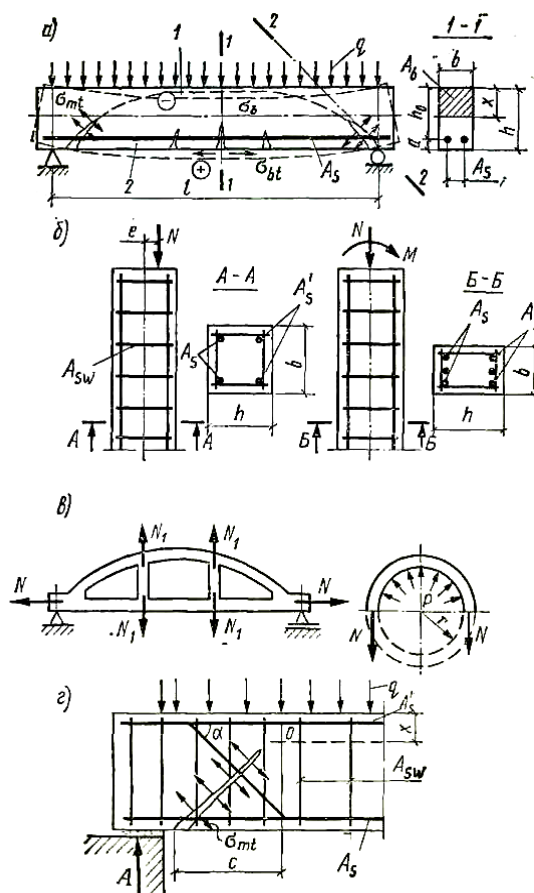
Схемы работы железобетонных элементов под нагрузкой
